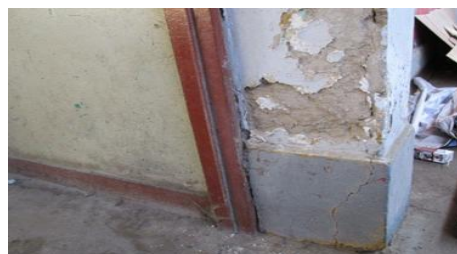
Desprendimiento de concreto en columna. Fuente: Elaboración propia
